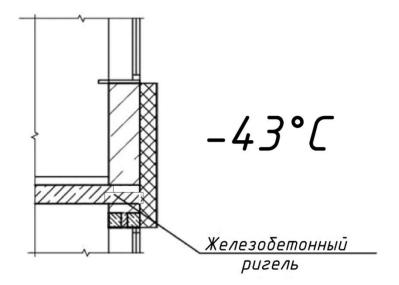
Схематическое изображение вертикального разреза стены с теплоизоляционным фасадом в зоне расположения светопроемов с оконным блоком
